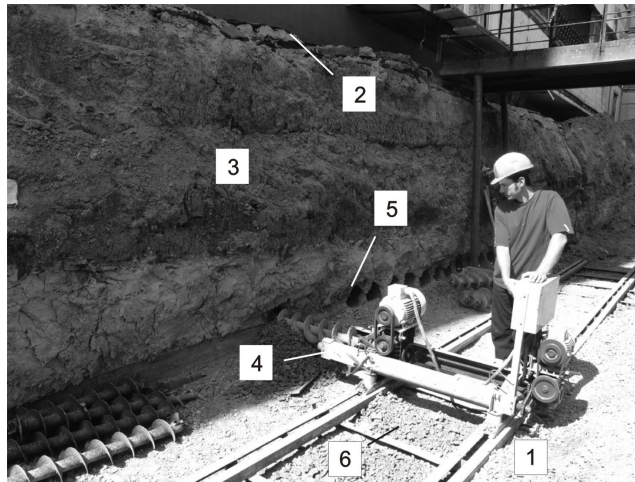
Подработка грунта в основании здания механическим бурением горизонтальных цилиндрических скважин: 1 – котлован; 2 – фундамент здания; 3 – откос котлована; 4 – буровой станок; 5 – горизонтальная цилиндрическая скважина; 6 – выбуренный грунт.
